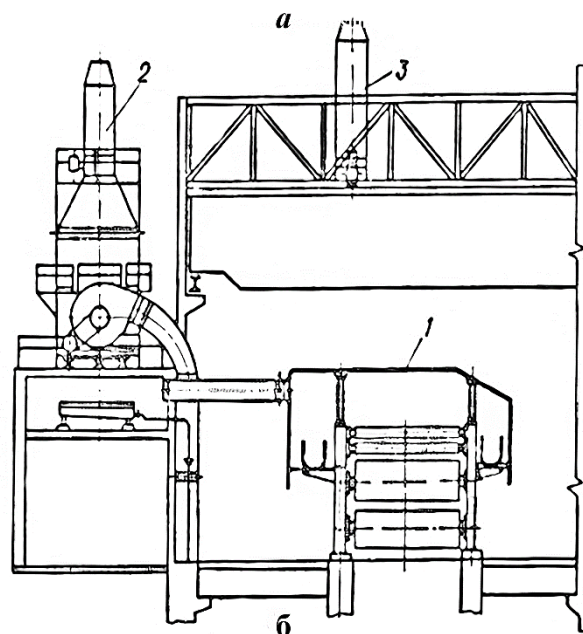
Схема вентиляции открытого типа для старых одноэтажных машин:
